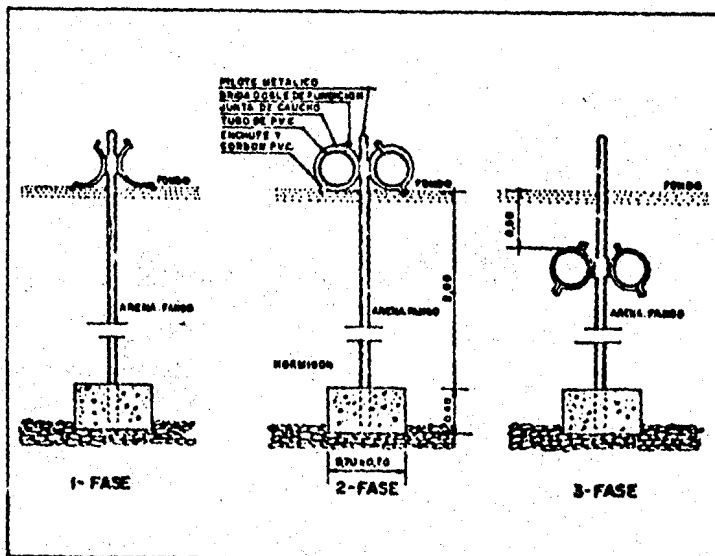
Fases de cimentación por pilote y anclaje enterrado
